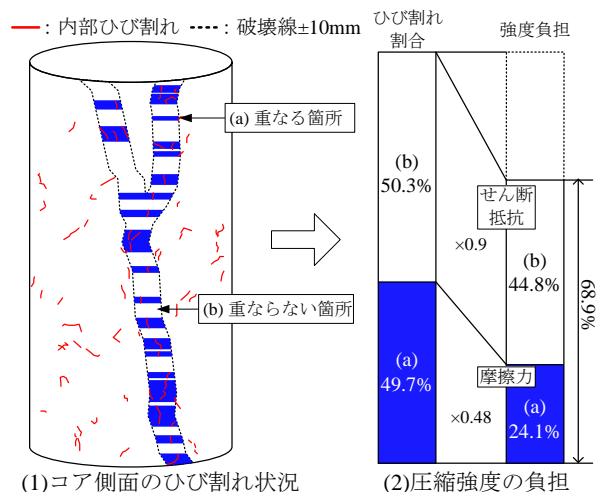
ひび割れ状況と強度低下率 (case7)
